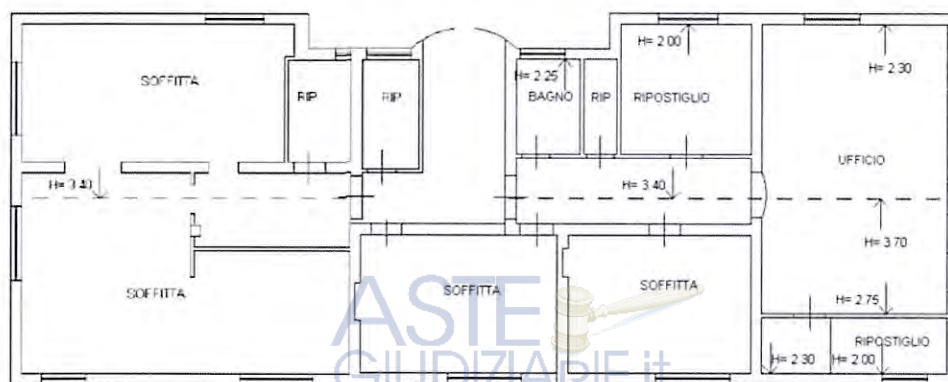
Estratto della planimetria catastale del piano primo del fabbricato
